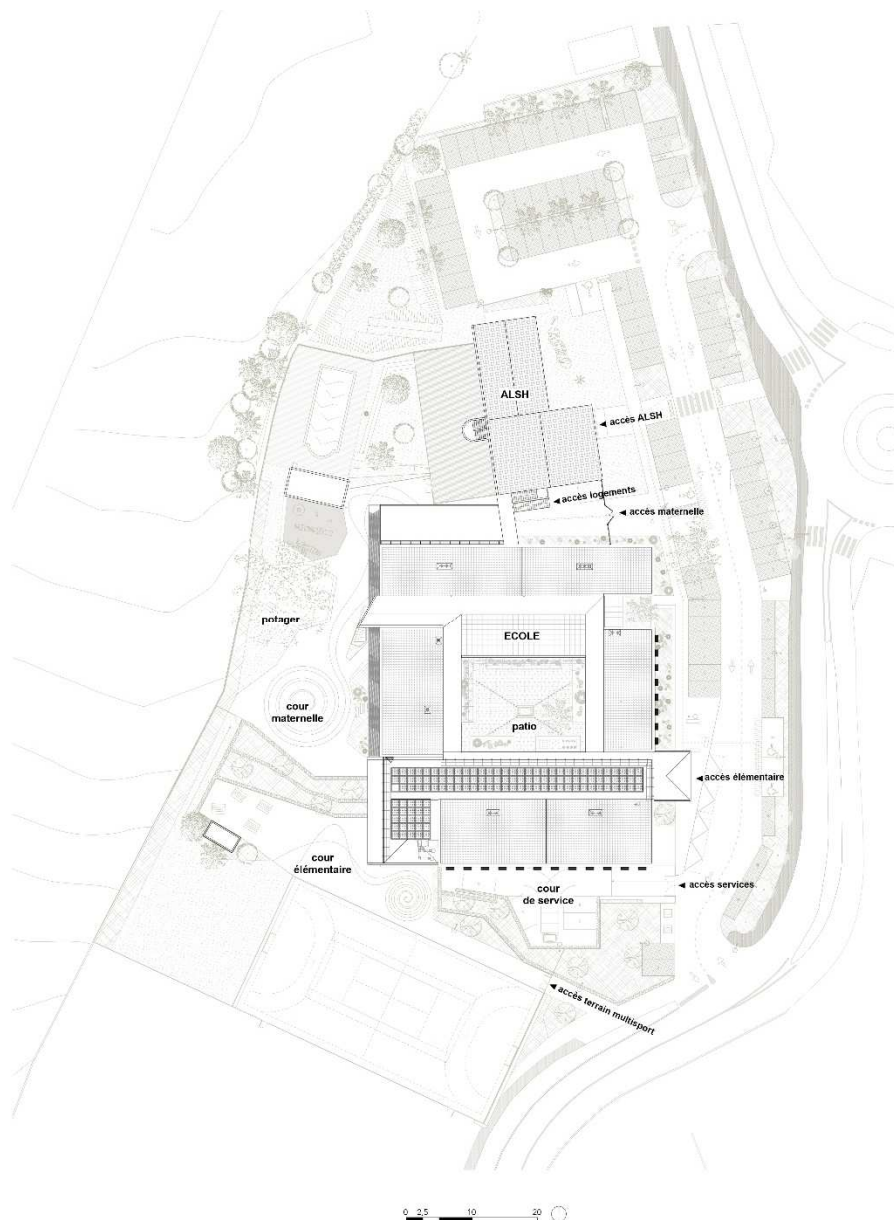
Plan d'implantation du projet du Groupe scolaire à Opio de Teissier Portal.
